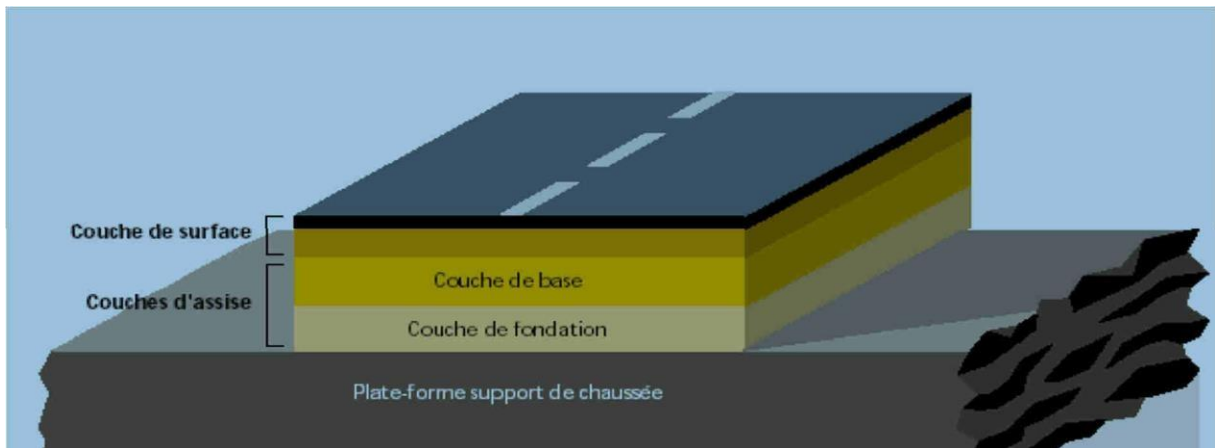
8. Structure type d'une chaussée souple (jafijaf, 2015, p. 12)
